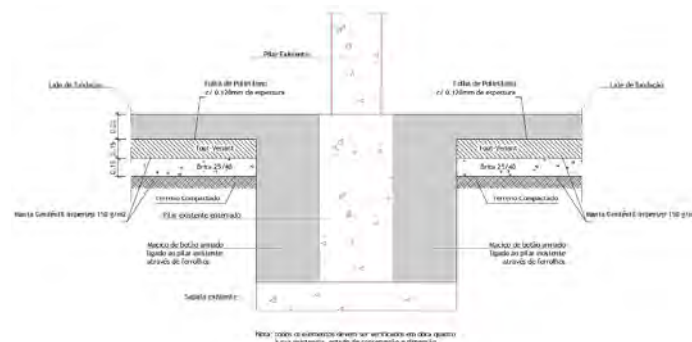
Reforço das fundações dos pilares existentes a manter, nos edifícios C/D fonte: Projeto de Execução
